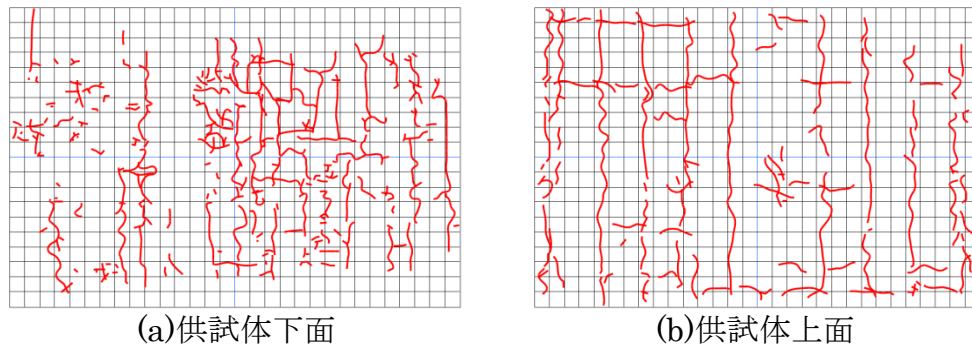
腐食ひび割れ発生状況(内在供試体)
